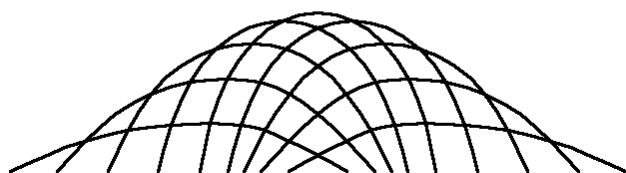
Profil de la grille carrée avec tous les appuis glissants sur le plan.
